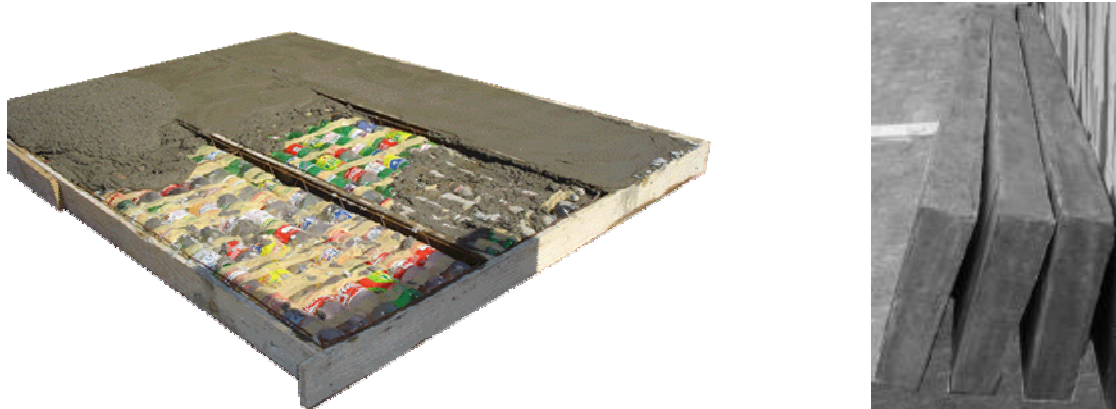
a - colocação da argamassa de revestimento e b - desmolde dos painéis de vedação.
